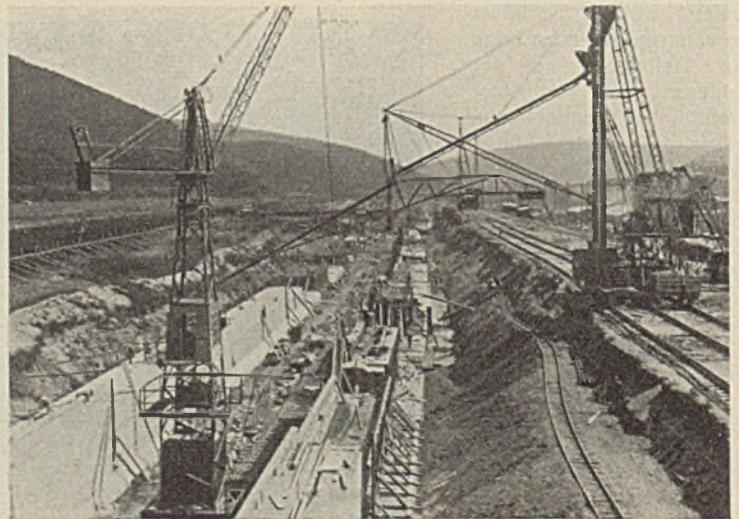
Staustufe Steinbach. Blick vom Unterhaupt auf die Schleusenbaustelle.
